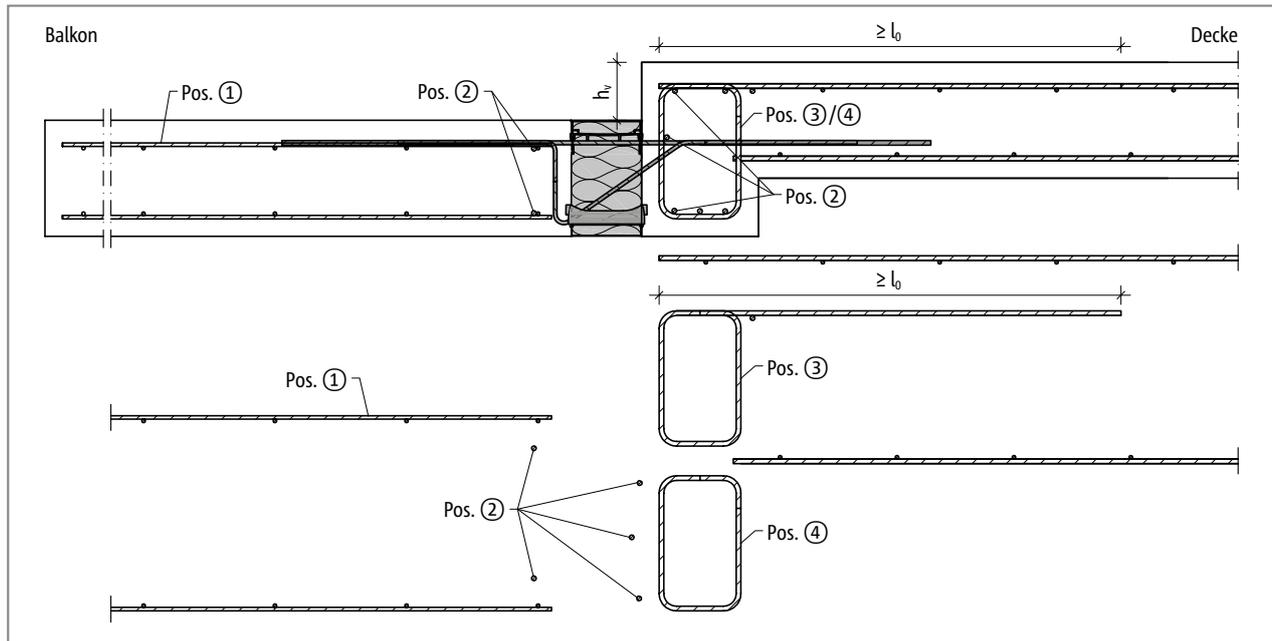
Schöck Isokorb® Typ KXT: Bauseitige Bewehrung für kleinen Höhenversatz
